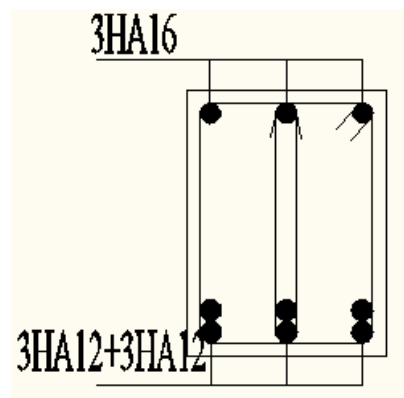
Ferrailage sur appuis d'une poutre secondaire.
